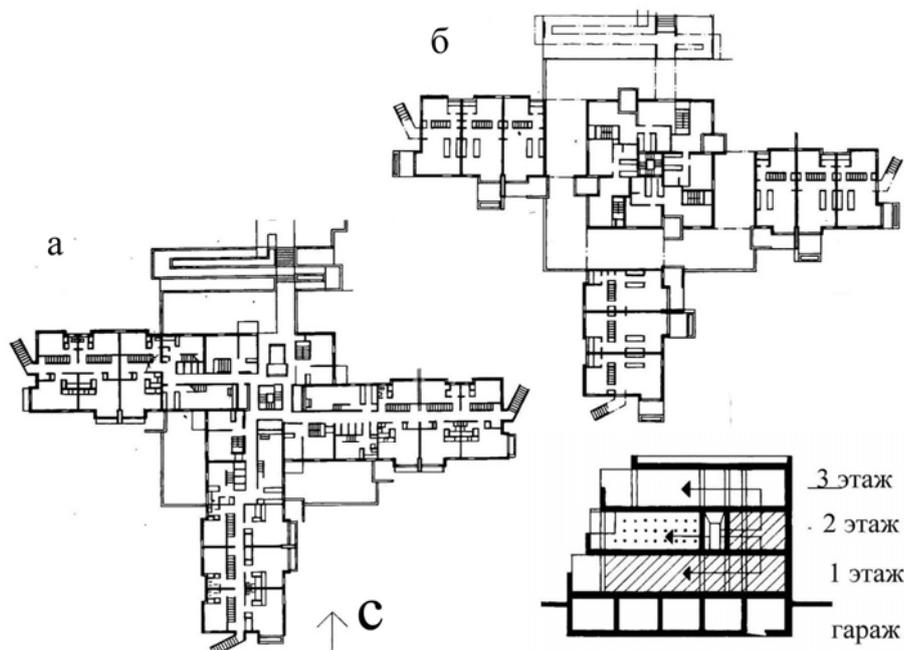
2-3 этажный коридорный дом; квартиры в одном и двух уровнях. Входы в квартиры осуществляются через коридоры, расположенные на втором этаже; а) план первого этажа; б) план второго этажа; в) разрез по зданию
